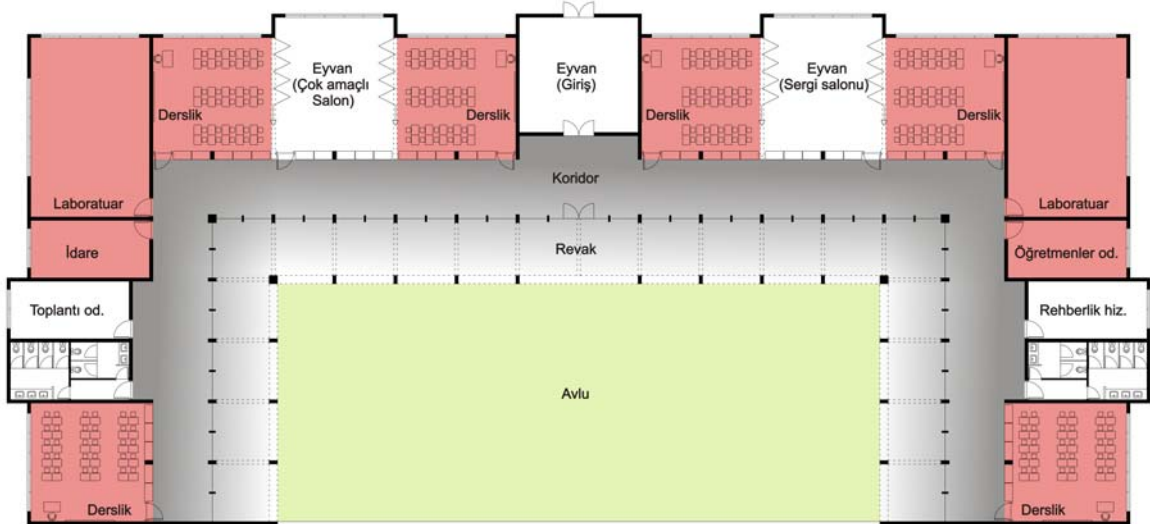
Dört derslikli plan şemasından türetilen model çalışmaları
